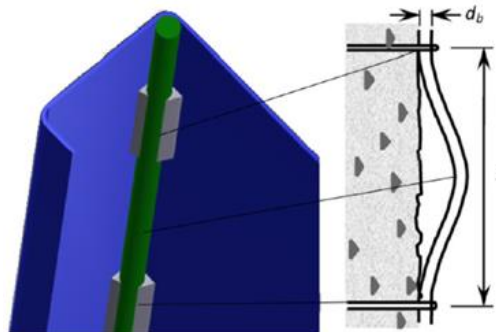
Longitud crítica de puntos de soldadura. [1]
